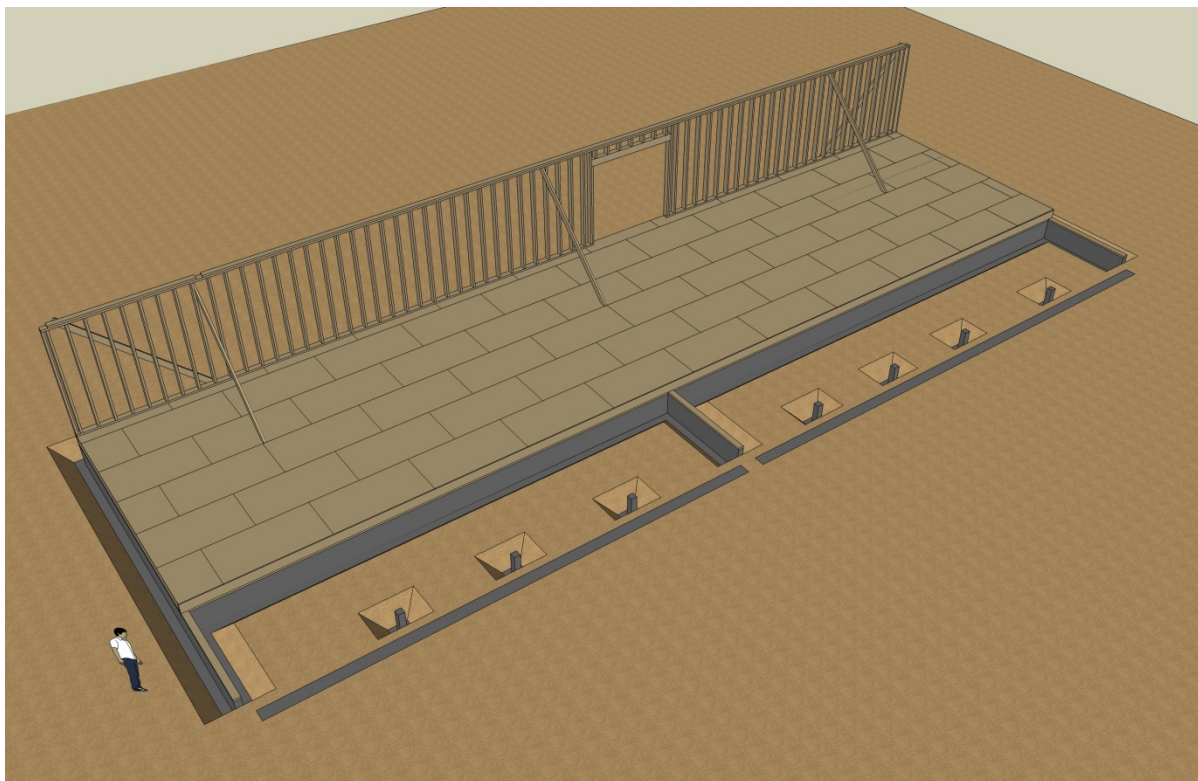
Montagem de parede exterior e estabilização temporária com escoras pelo interior e tirantes pelo exterior.
